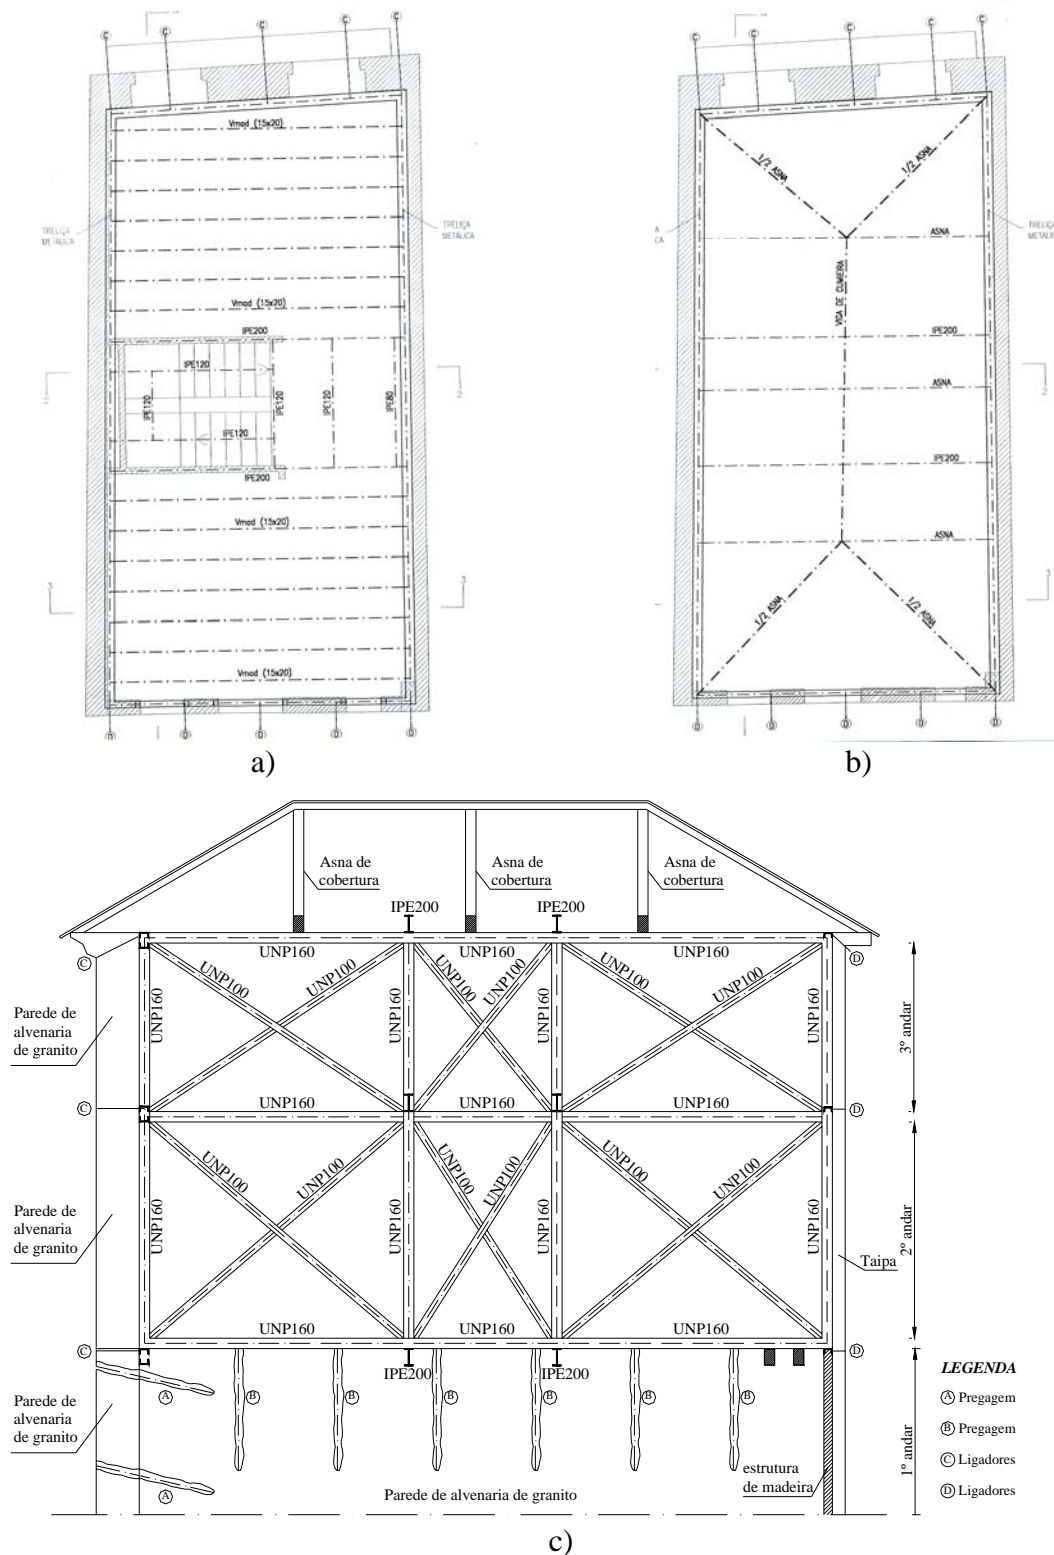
Outra proposta de intervenção no edifício; a) Planta estrutural dos pavimentos 1, 2 e 3; b) Planta estrutural da cobertura; c) Solução proposta de reforço das paredes laterais, com recurso a perfis metálicos UNP e IPE
